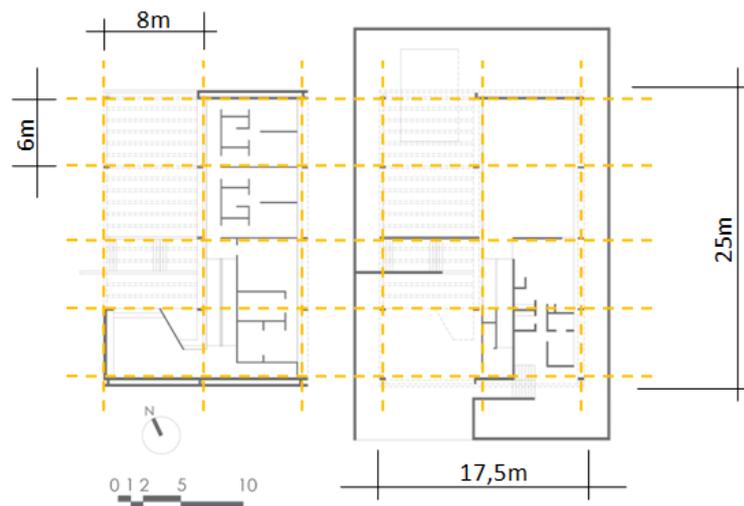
Residência Niclewicz, planta pavimento intermediário e 2º pavimento, e planta 1º pavimento/escritório no recuo, com intervenção gráfica da autora.
